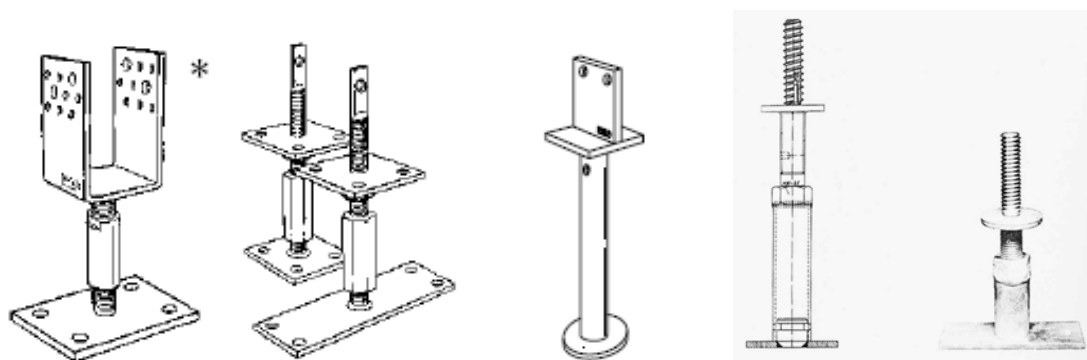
Algunos tipos de bases regulables para pilares de madera: se apoyan sobre placas de montaje o se hormigonan directamente. Los tres primeros marca Bilo, los últimos dos son Top-Foot.
